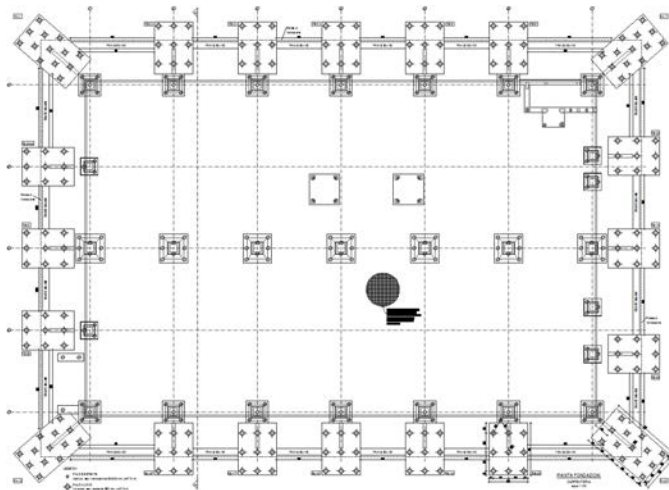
Pianta fondazioni dell'intervento di adeguamento.
